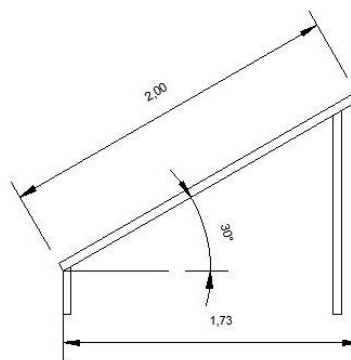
Vistas del Panel Tipo a Instalar.
